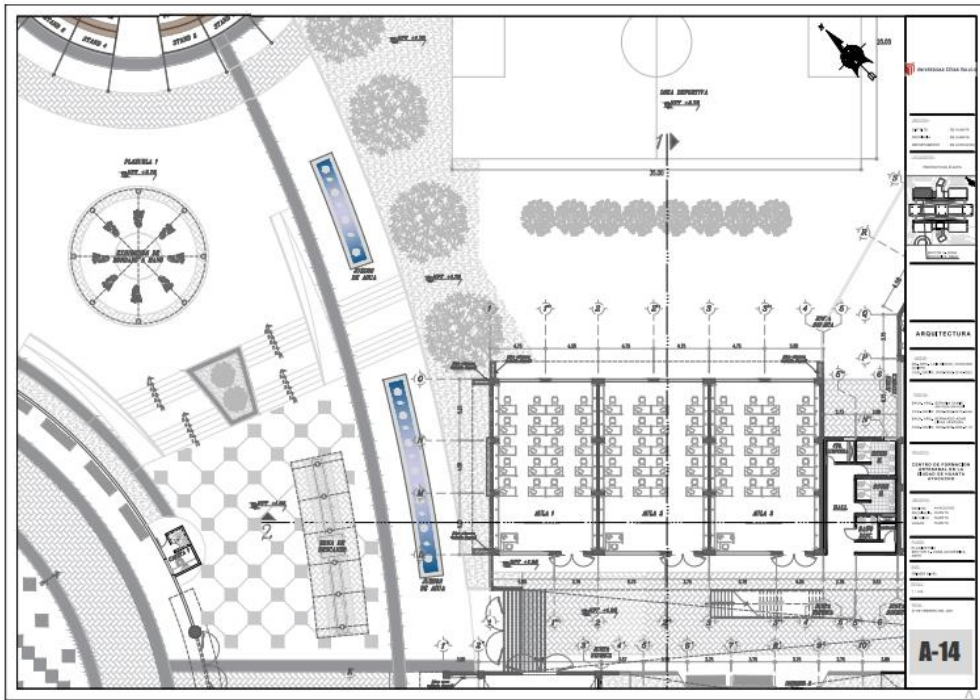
Planimetría del sector 3 ubicado en el piso 1. Escala 1/100.
